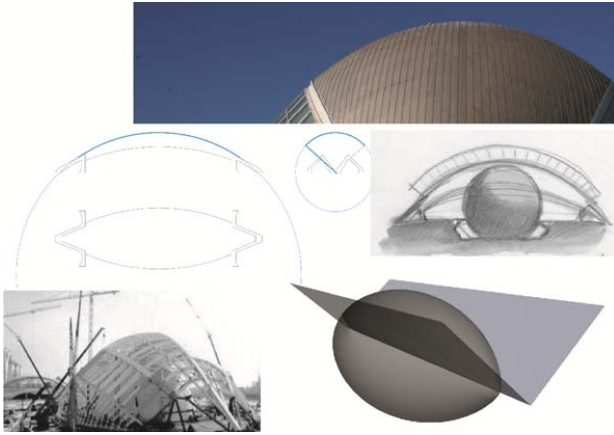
Cubierta de l'Hemisfèric. 1996-98. Santiago Calatrava
